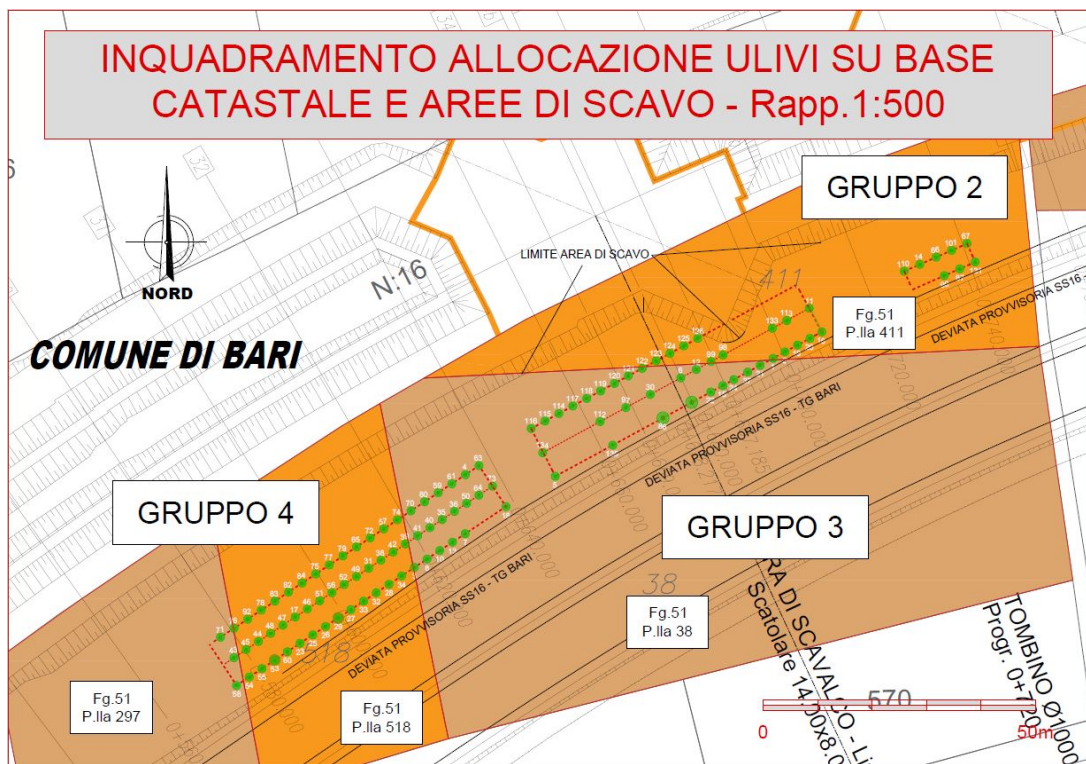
Planimetria attuale dei Gruppi 2, 3 e 4
